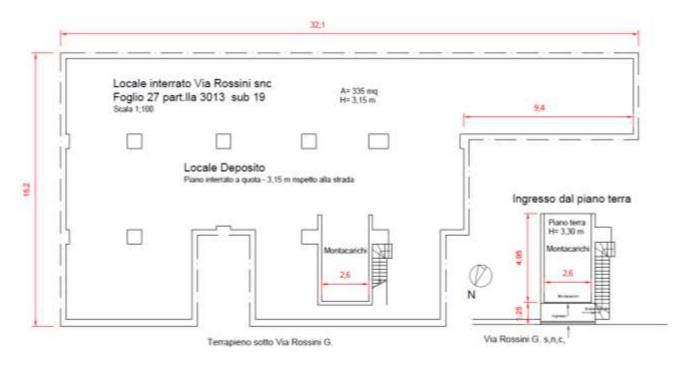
Planimetria locale piano interrato come rilevato al sopralluogo via G. Rossini
